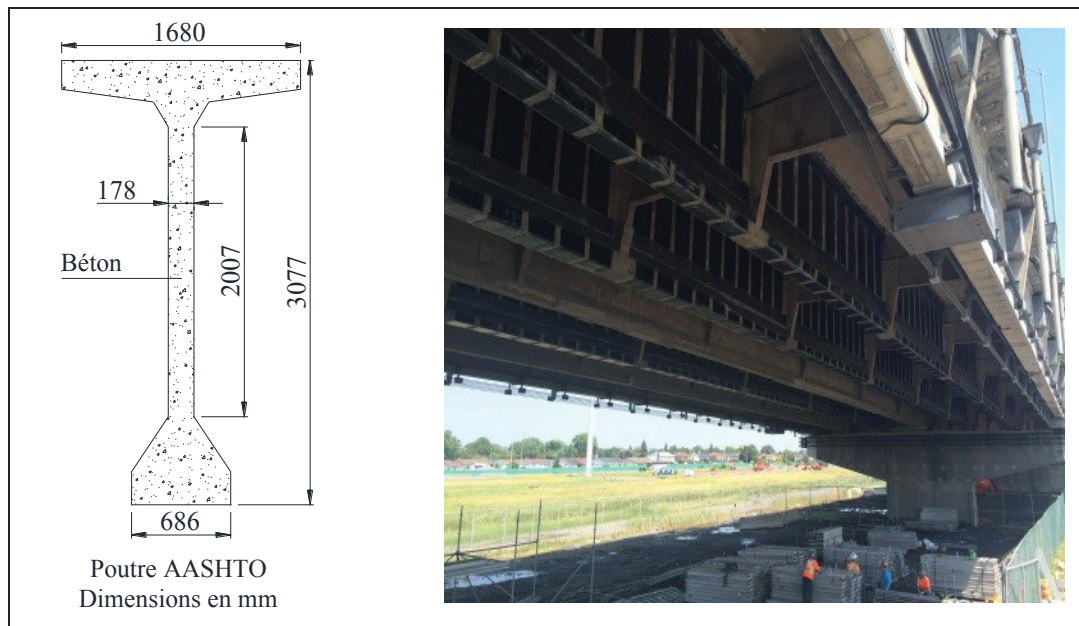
Renforcement au cisaillement des poutres du pont Champlain
